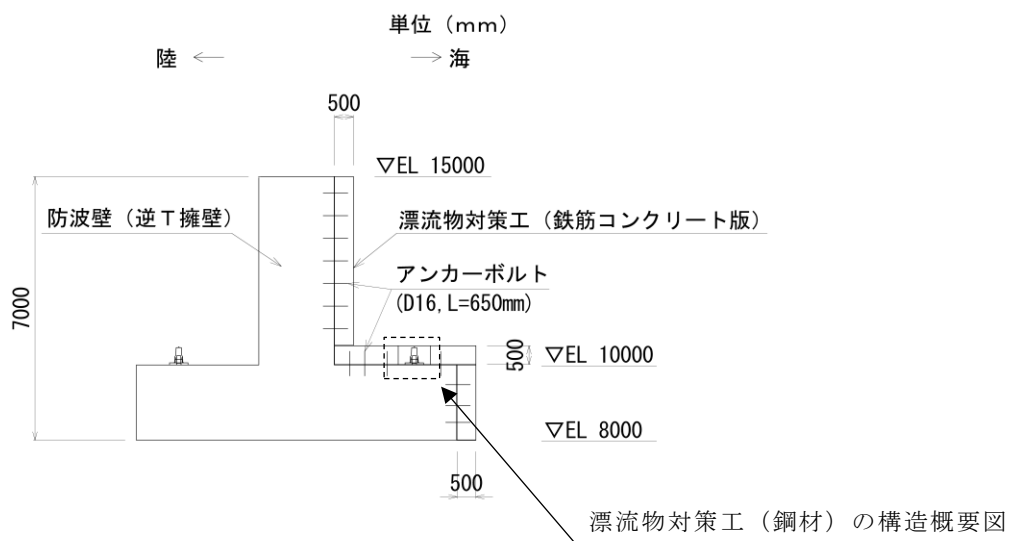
(2) 漂流物対策工 (鉄筋コンクリート版) のアンカーボルト配置図 (断面図)
